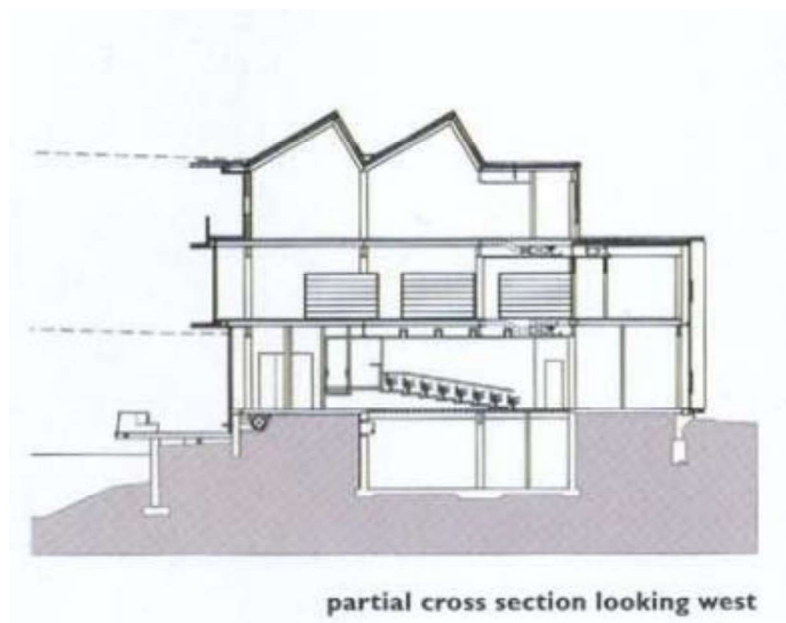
Corte Transversal passando pelo pavimento técnico (Subsolo) auditório menor (Térreo), biblioteca (1º Pavimento) e ateliers (2º pavimento). (Fonte: Architectural Record, 2007).
